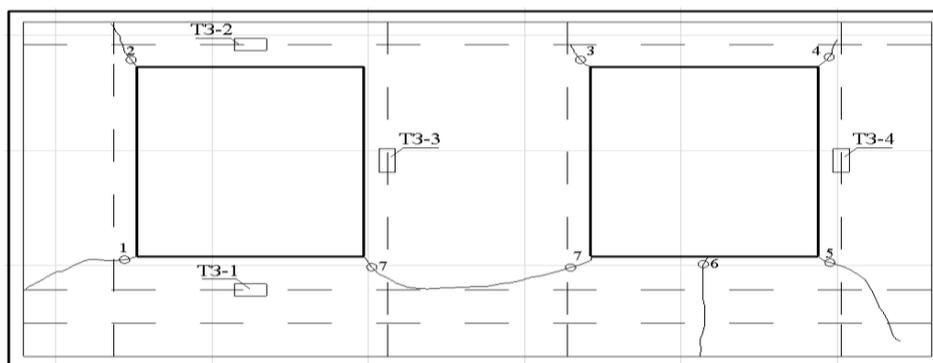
Схема установки приборов для оценки потерь в стержнях при передаче усилия на бетон и замера ширины раскрытия технологических трещин: 1ч7- номера трещин с местами для замера их величины; Т3-1ч Т3-4-тензометры Гугенберга
